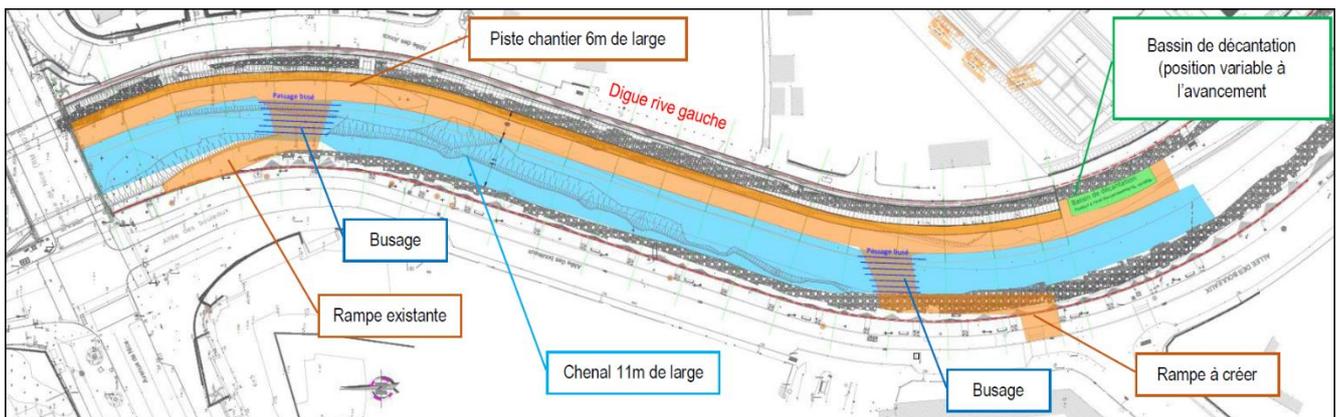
Plan général des installations de chantier. Le cours d'eau s'écoule de la gauche vers la droite.
